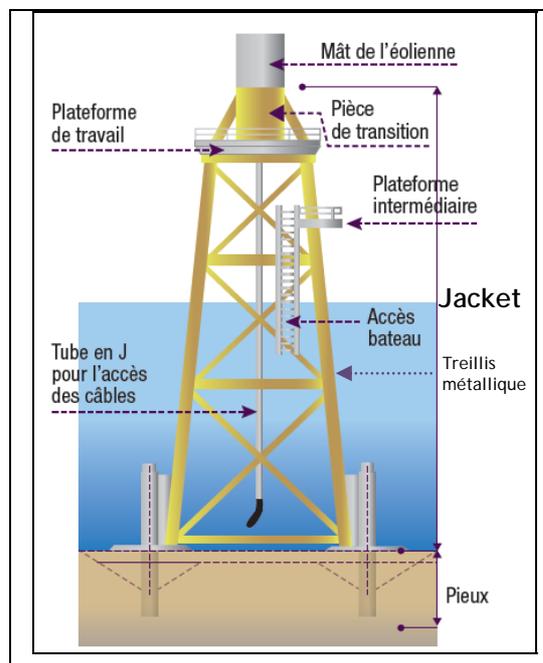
Le schéma de principe d'une fondation de type « jacket »
